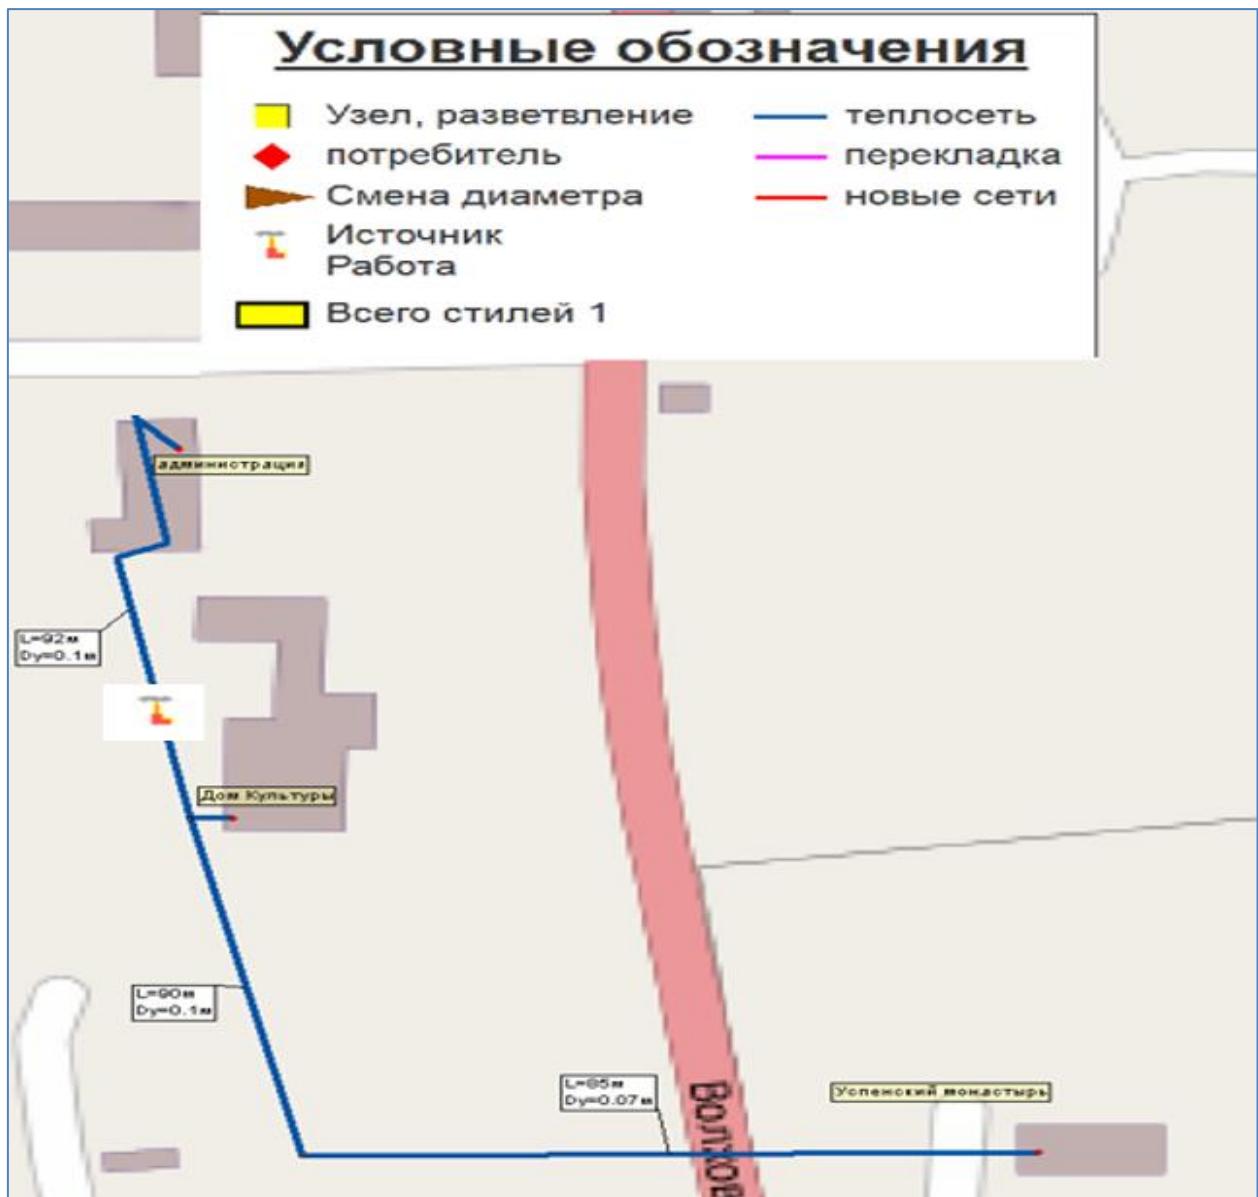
Схема тепловых сетей от модульной газовой котельной
